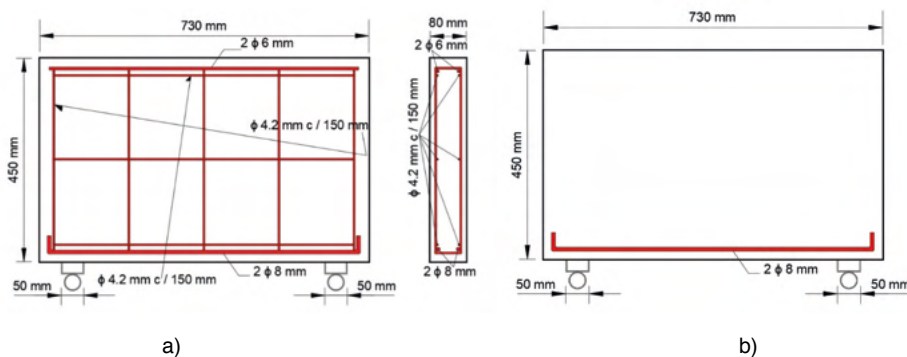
Dimensiones geométricas y detalle de armaduras de los especímenes ensayados: a) Viga con armadura de corte; b) Viga sin armadura de corte
